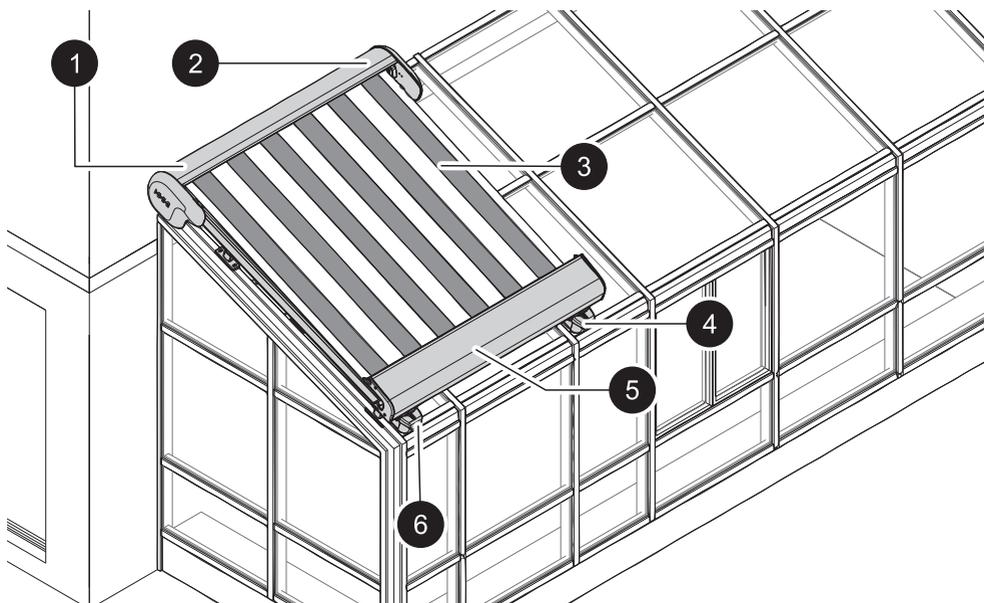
Vue d'ensemble du store de véranda TARGA PS6000
